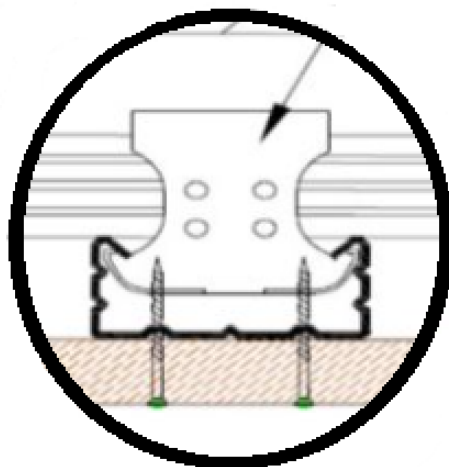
б. Монтаж двухуровневого соединителя профиля ПП 60x27
